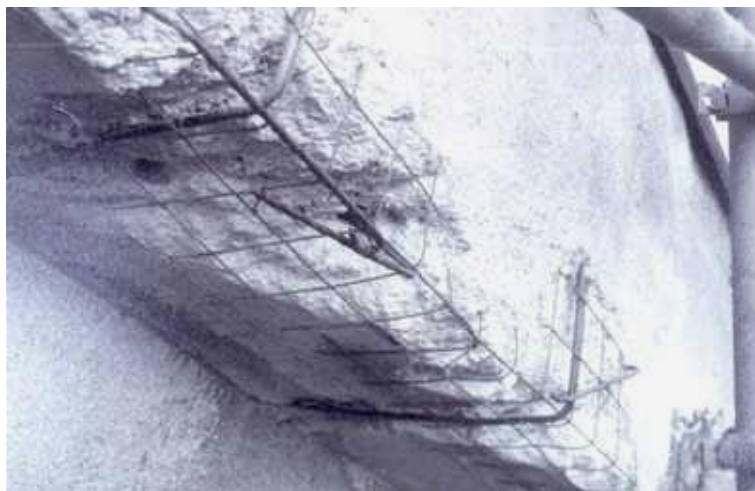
bandeau après purge du béton désorganisé, scellement de nouvelles armatures et avant bétonnage par projection (crédit photo DDE 74)
